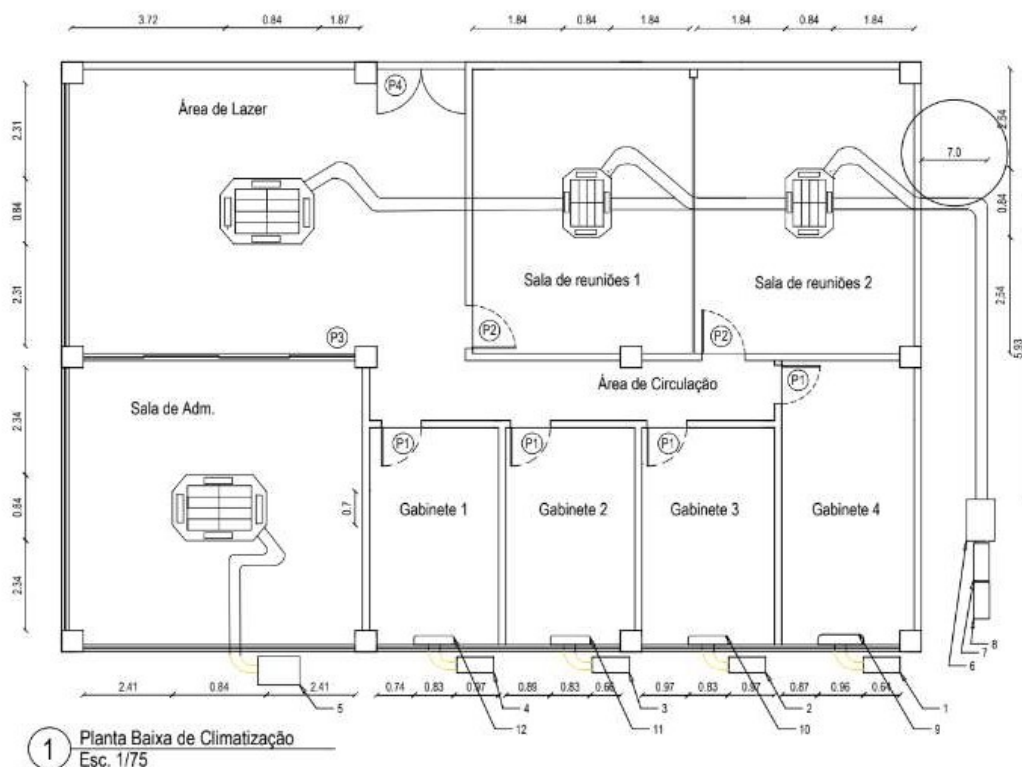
Planta baixa de climatização criada no AUTOCAD.
